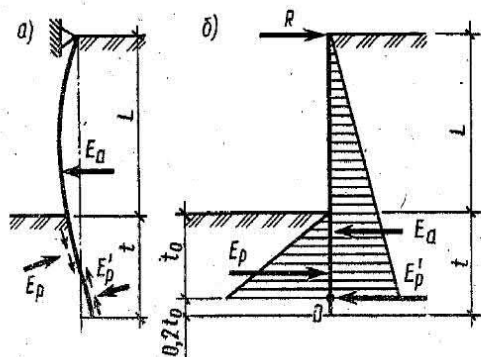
Расчет заанкеренной стенки по схеме Блюма—Ломейера:
